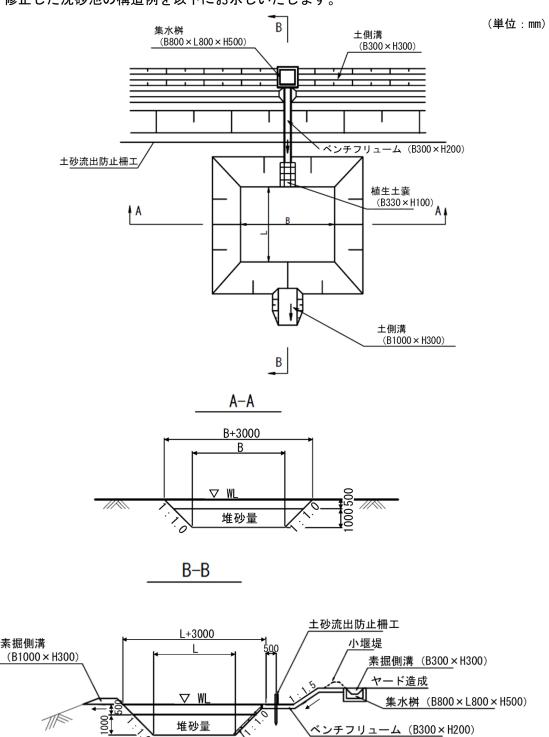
(1) 沈砂池の構造例(平面図と断面図)
